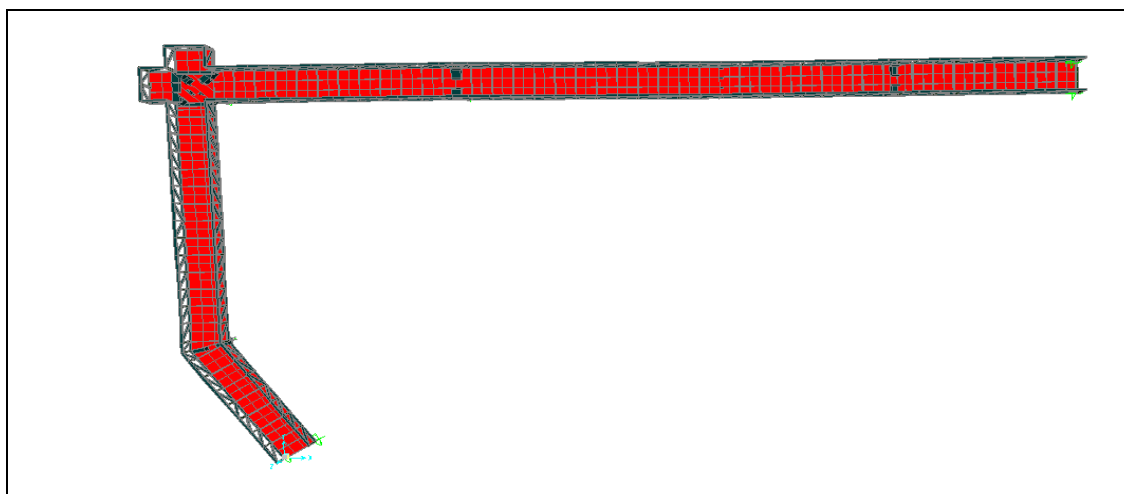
Modelo vista en planta del proyecto definitivo del puente peatonal
